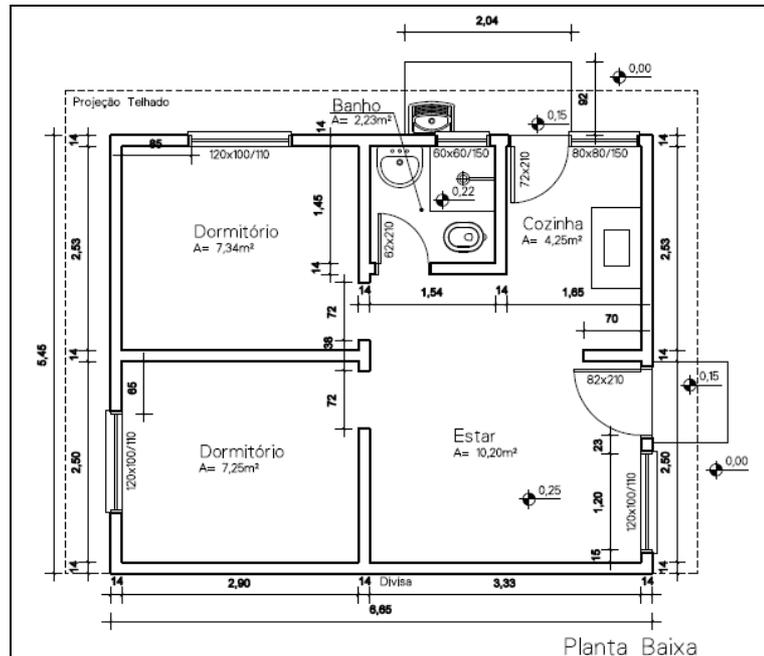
Planta Baixa – Casa conjunto habitacional Tancredo Neves – 36,24m²
